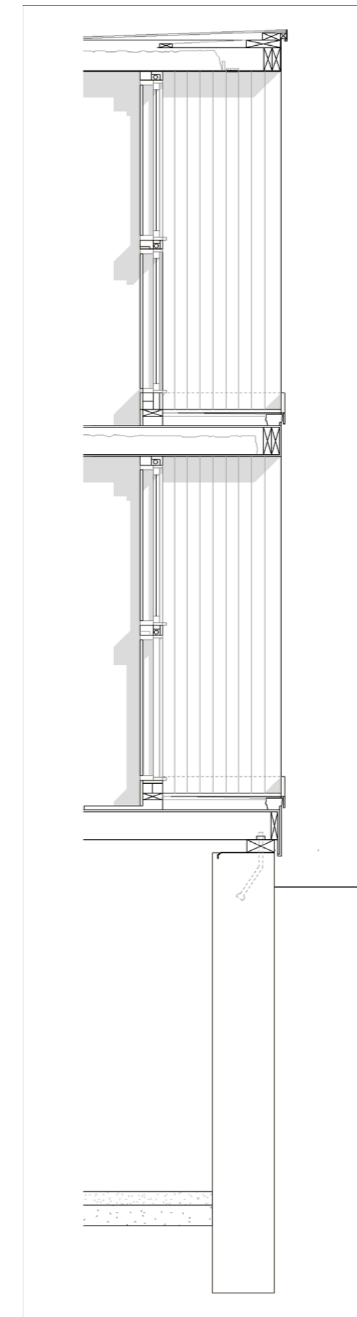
Vista sección constructiva modelado en Revit del proyecto Fisher House. Tratamiento de visualización: sombras y de línea oculta.
